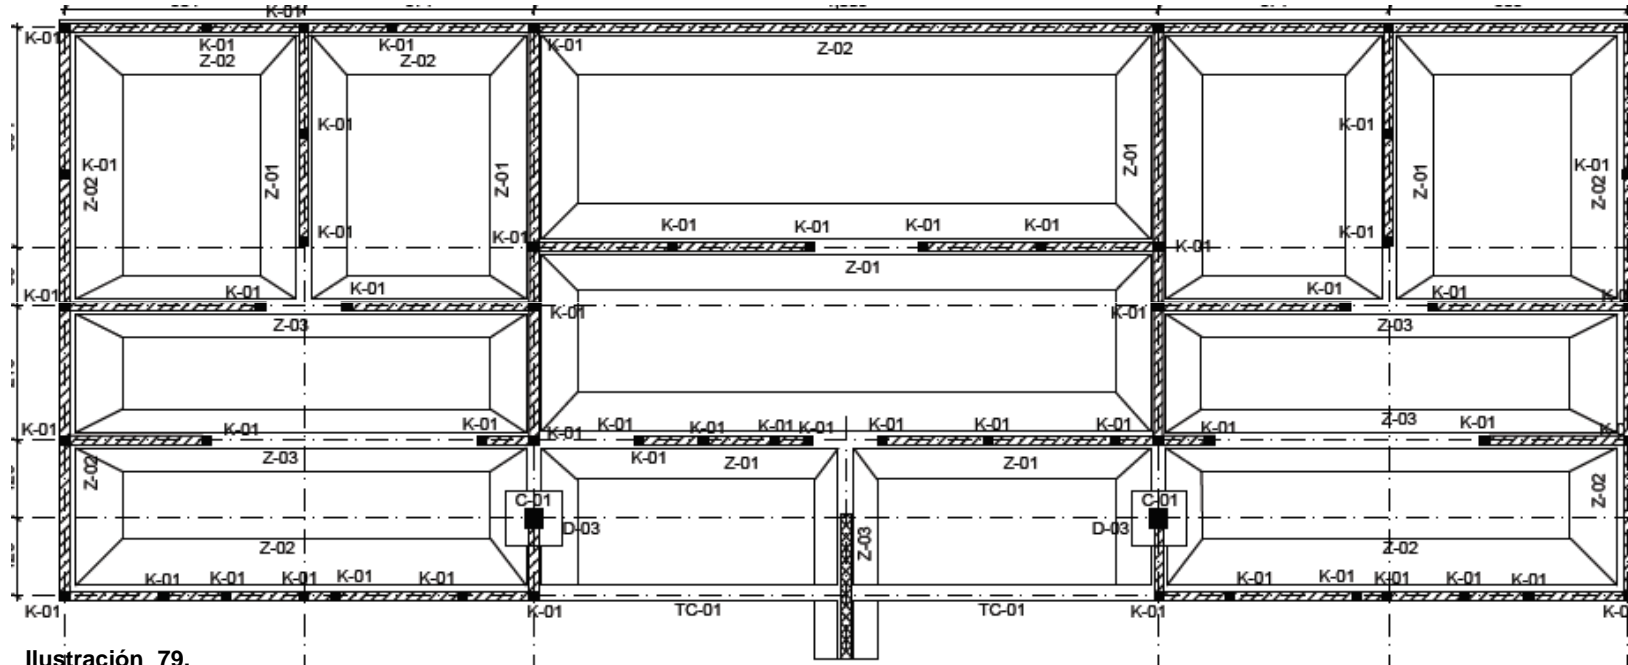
Acercamiento de la Planta de cimentación del modulo básico.
